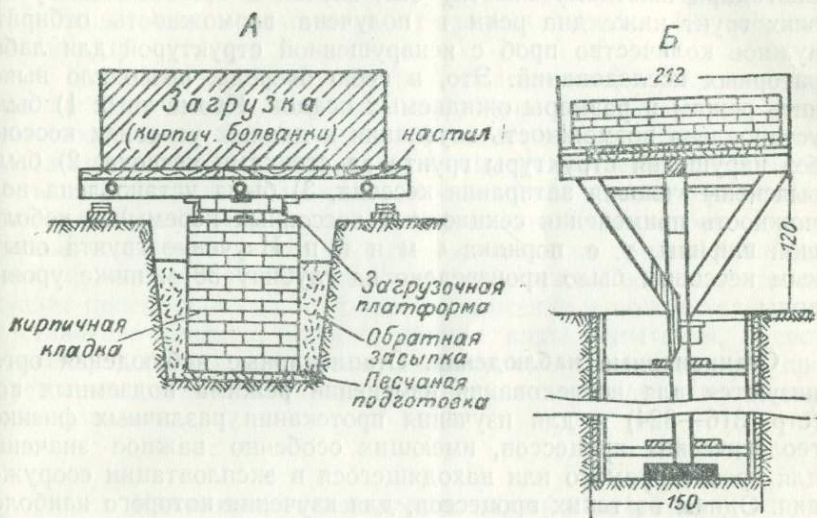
Схемы испытания грунта пробными нагрузками: А — способ опытного фундамента, Б — способ штампа.
